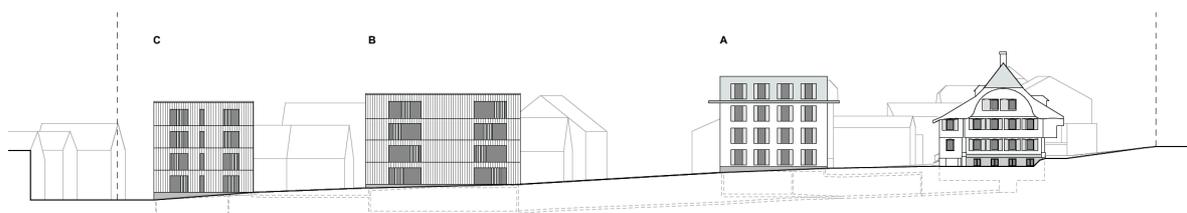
Geländeschnitt mit den Gebäuden A, B und C in der Variante 3 mit je 4 Vollgeschossen.
